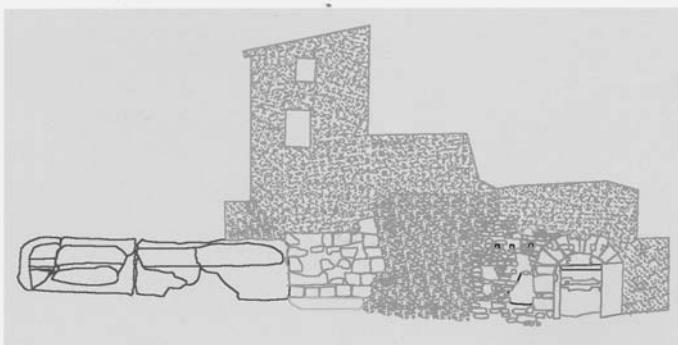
El Sequeral. Alzado desde Murallas Bajas.
